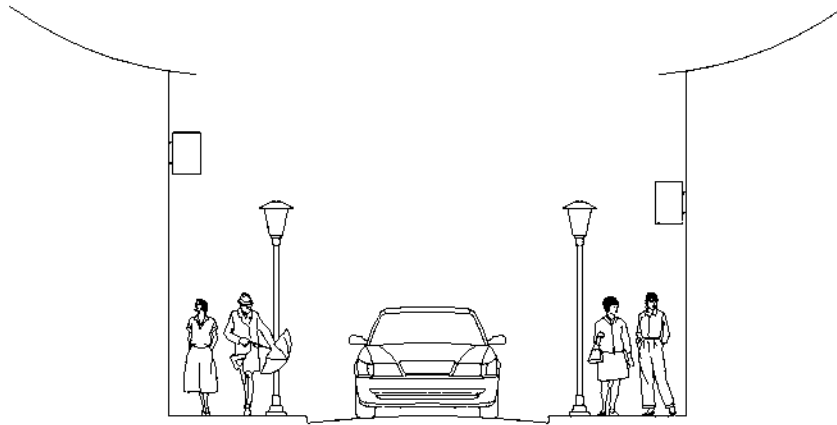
Corte esquemático da proposta para a Rua de Santana.
